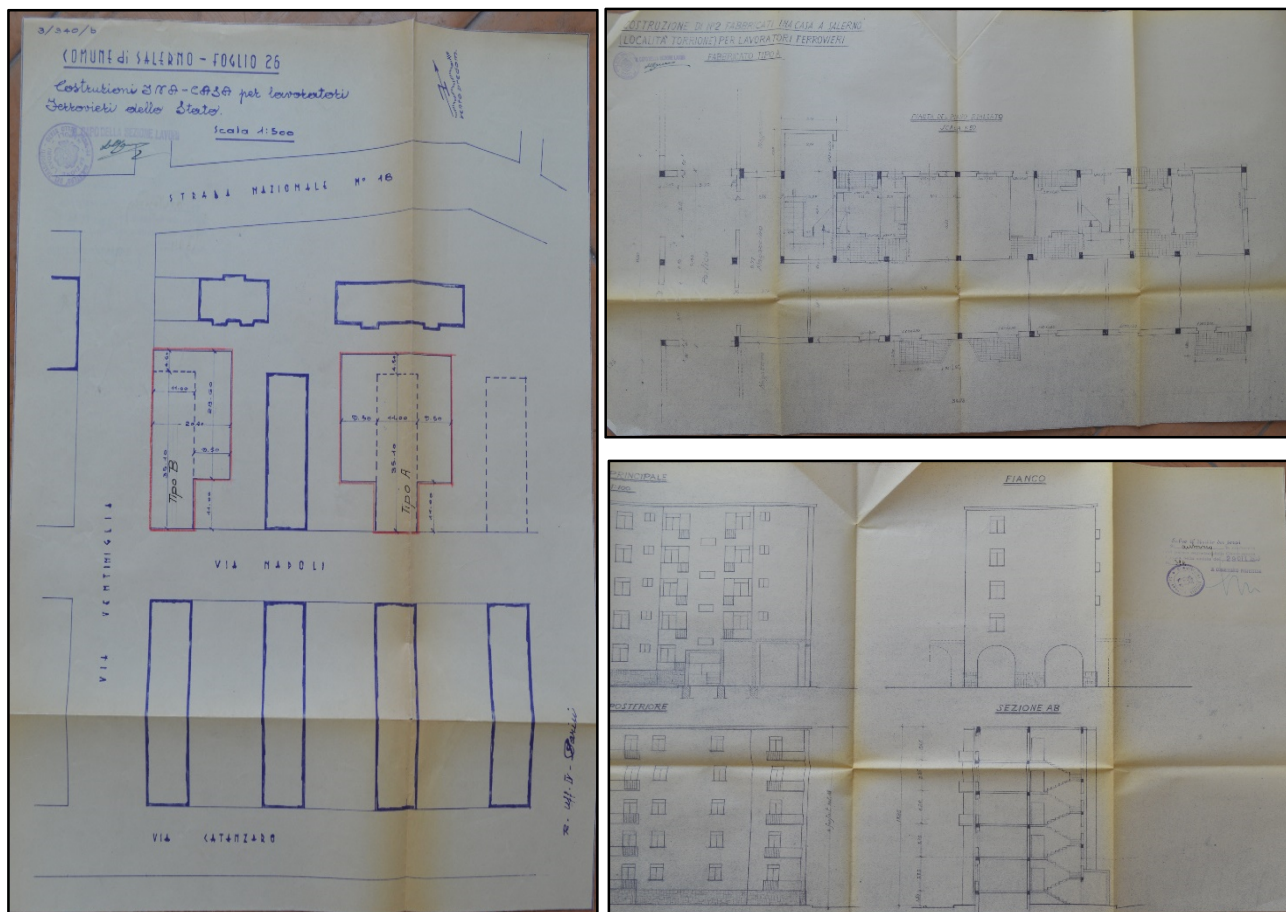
Planimetria generale di Torrione, con l'individuazione dell'edificio ENAR rispetto alle case dei Comunali e prospetto posteriore. Fonte ASCS.
